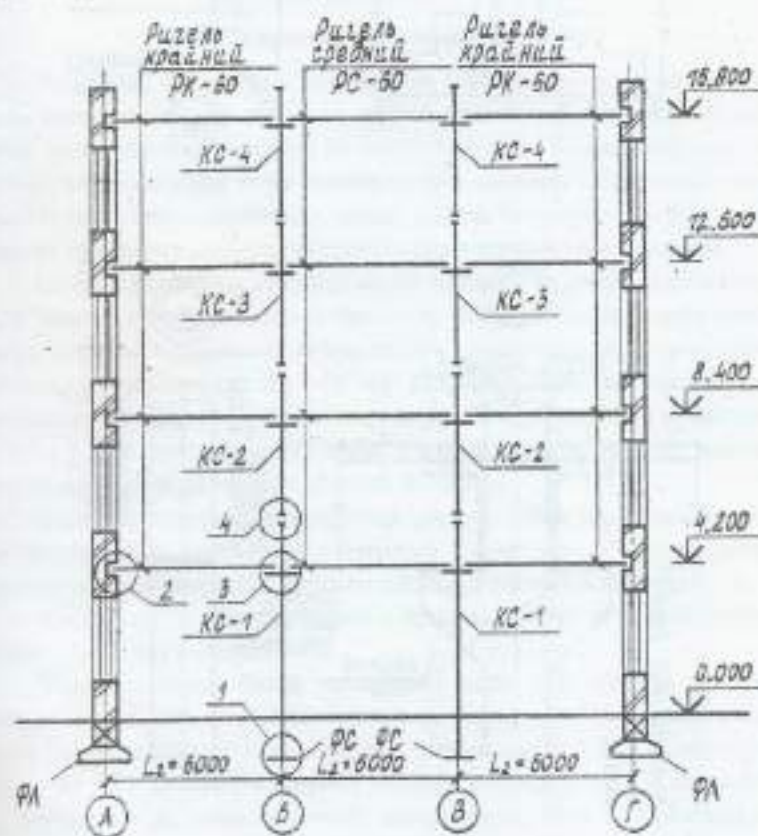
Поперечник многоэтажного промышленного здания с неполным каркасом
